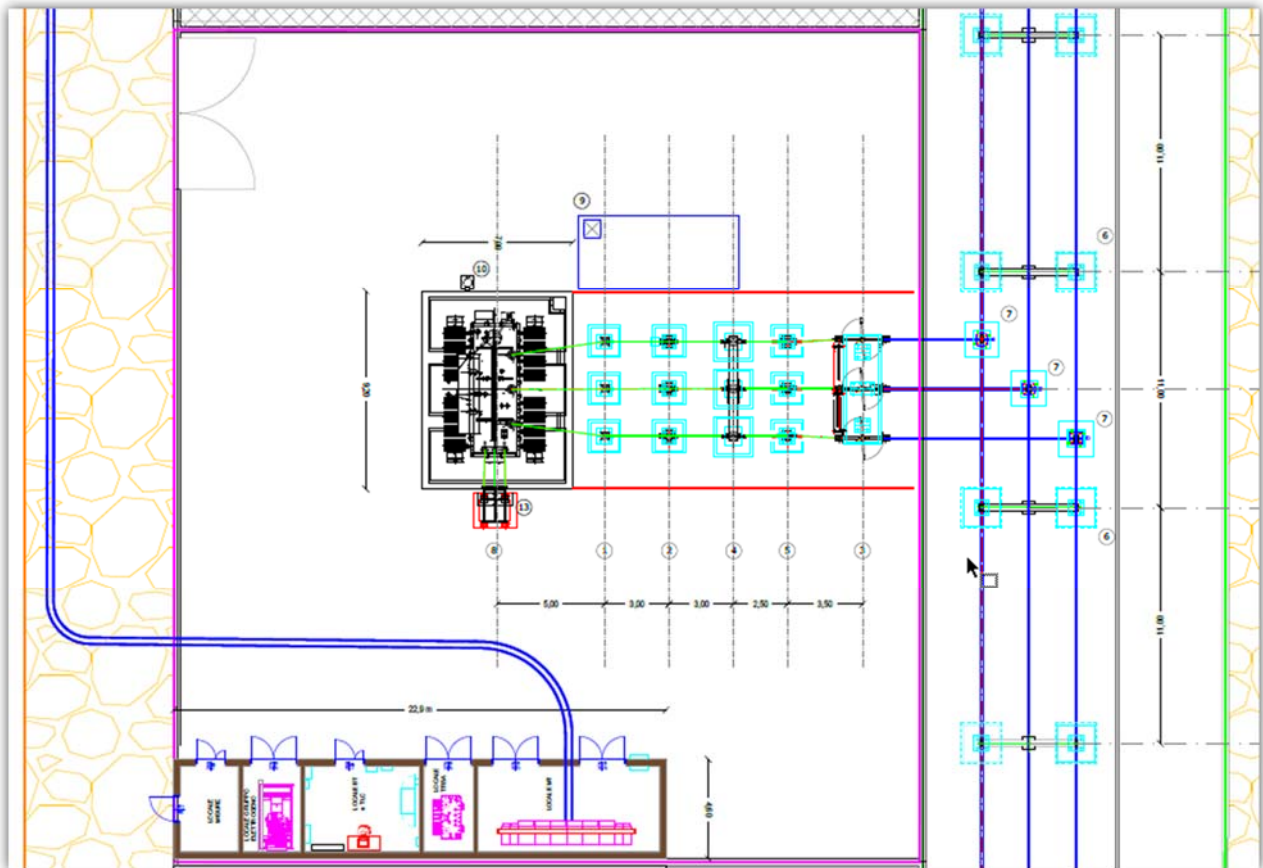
Planimetria elettromeccanica della SSE, con stralcio delle sbarre principali per la condivisione di Stallo.
